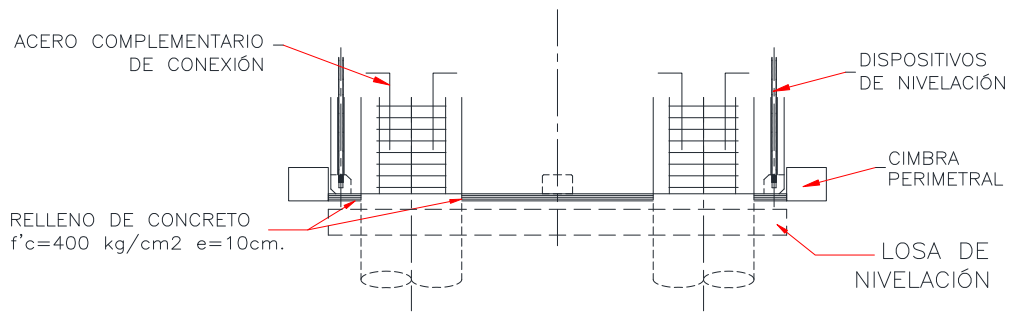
Detalle de anclajes en pilas (Fuente: Especificaciones generales del proyecto)
